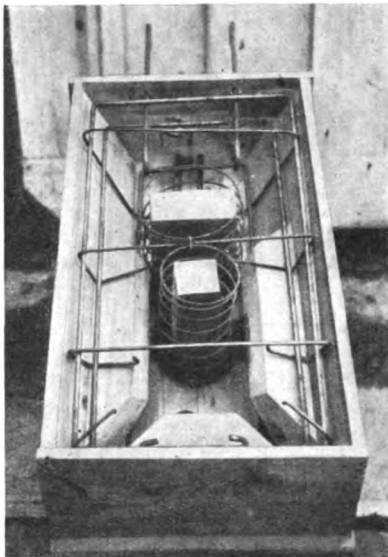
Schalform mit Armatur fertig zur Betonierung.
